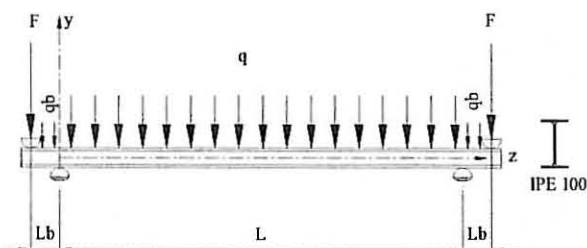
Sistema de carregamento para viga apoiada com apoios de forquilha.
